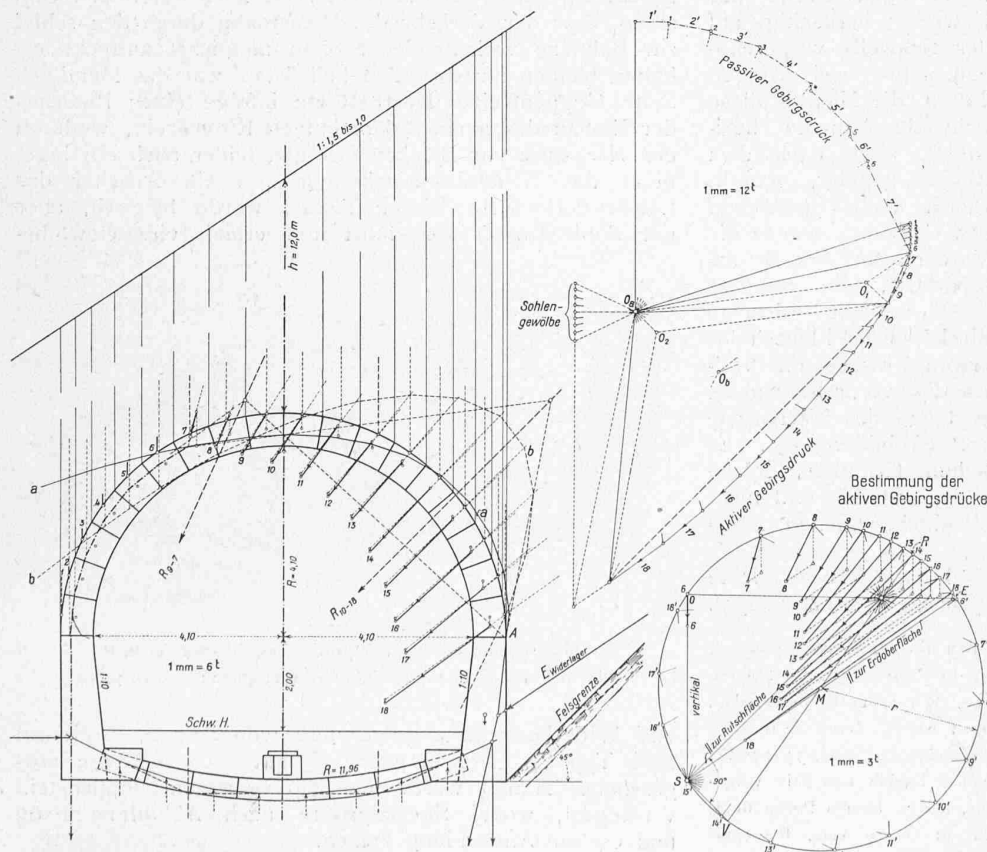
Statische Untersuchung der Druckverhältnisse im Sevistein-Tunnel II.
